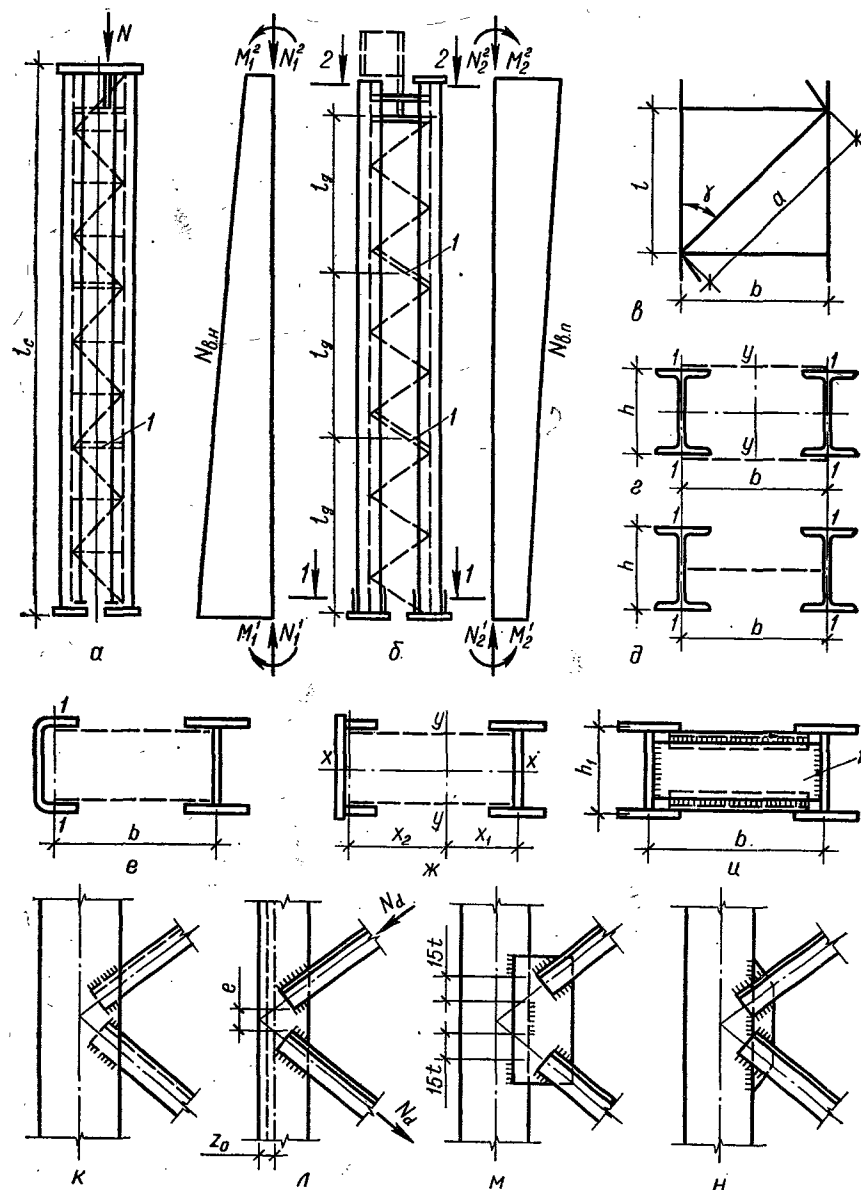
К расчету внецентренно-сжатой колонны с раскосной решеткой:
